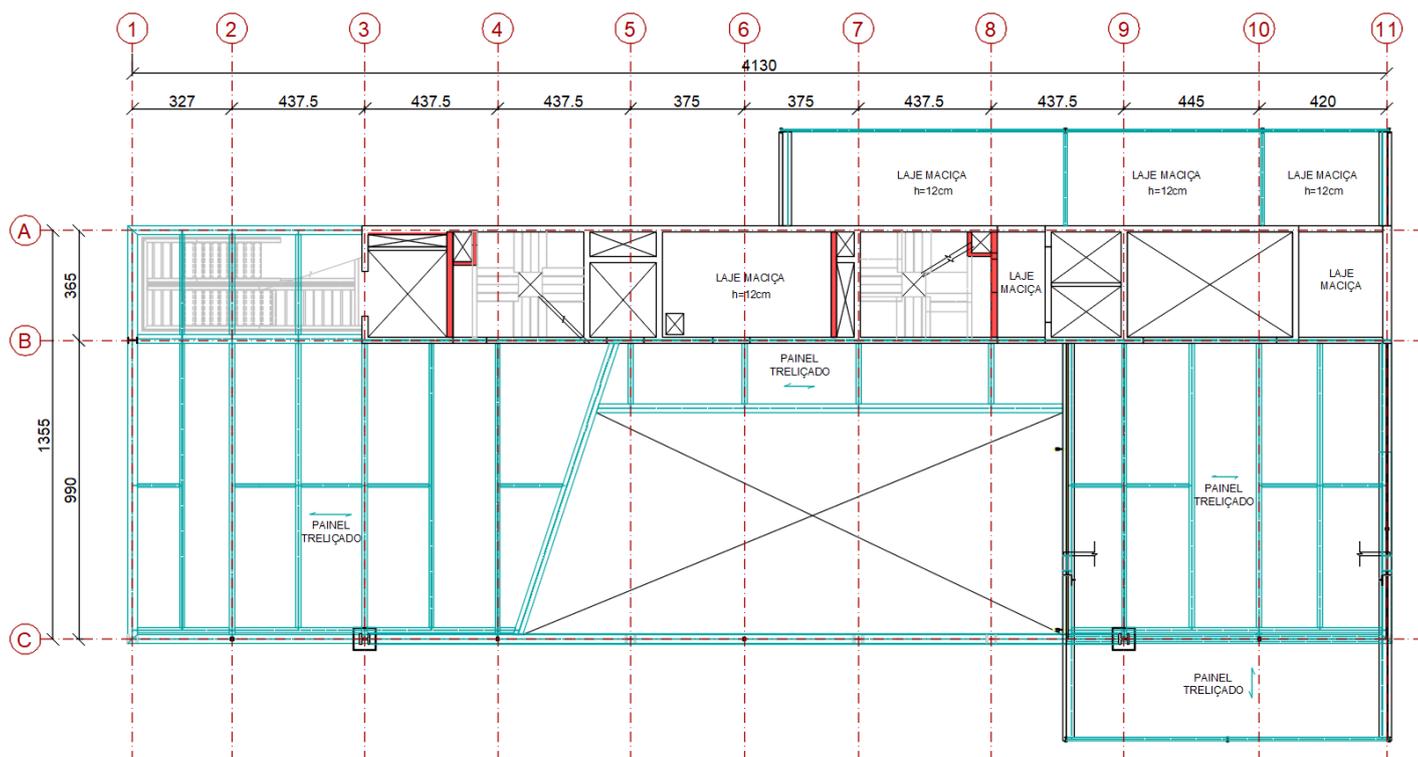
Planta de Arquitetura - Primeiro pavimento: biblioteca, administração
